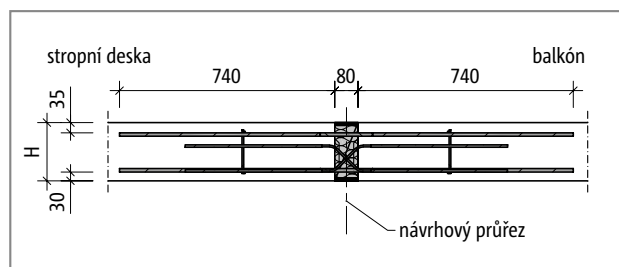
Schöck Isokorb® T typ QP-VV7 a QP-VV9: Statický systém
